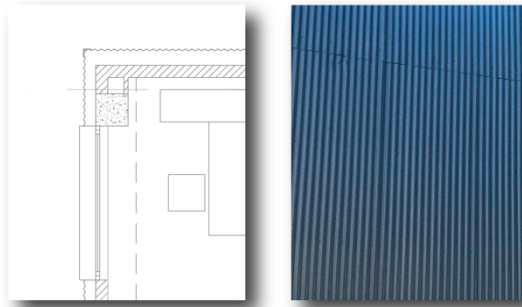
Planta y detalle del material de Fachada. Chapa Minionda. Fuente: Elaboración propia
